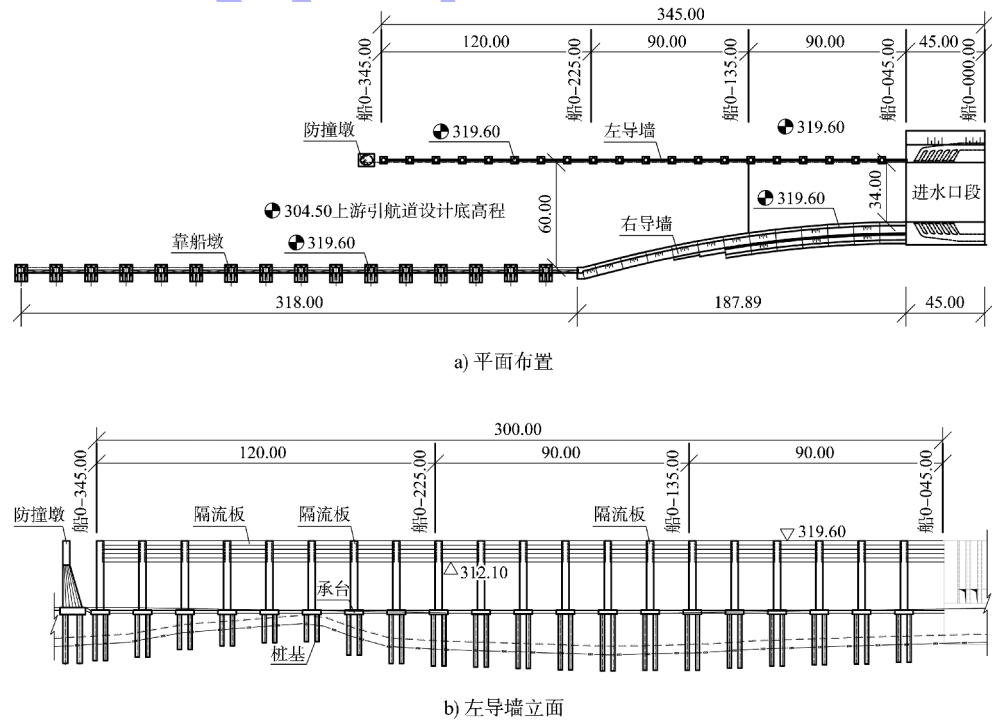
上引航道设计初始方案上引航道平面布置和左导墙立面 (单位: m)
